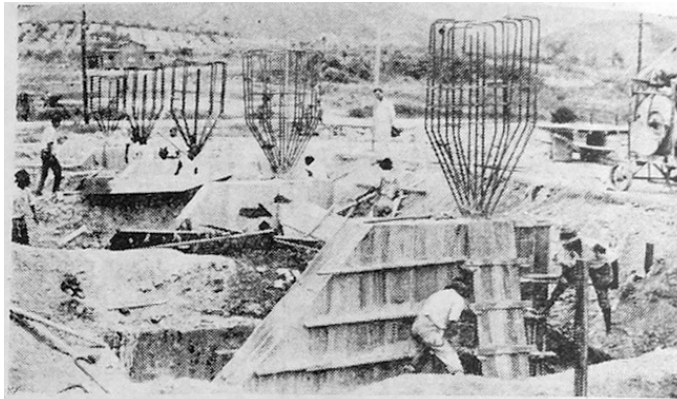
Construção das fundações e os ferros das articulações. FONTE: CONCRETO, 1938.
